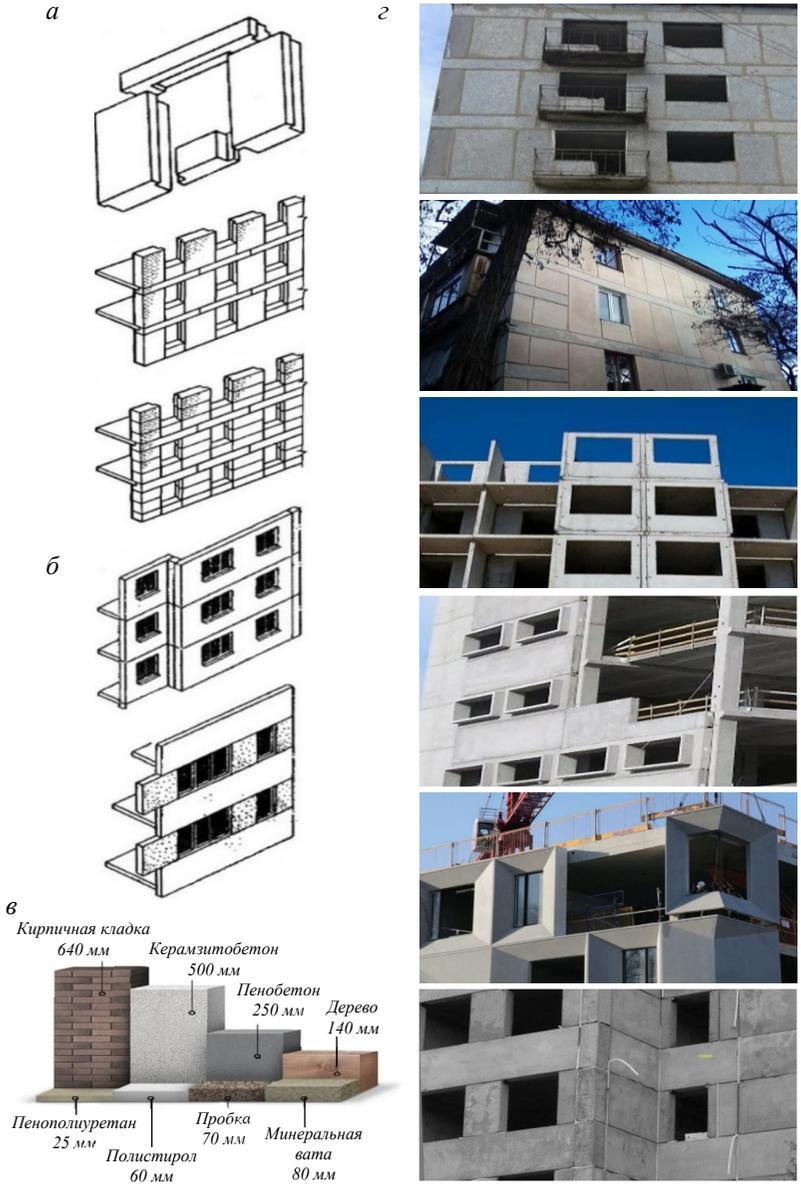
Примеры зданий со стенами из крупноразмерных элементов: *а* — элементы, схемы разрезки стен крупноблочного здания; *б* — схемы разрезки стен крупнопанельного здания; *в* — соотношение толщины стены и теплозащитных качеств материалов; *г* — примеры фасадов
